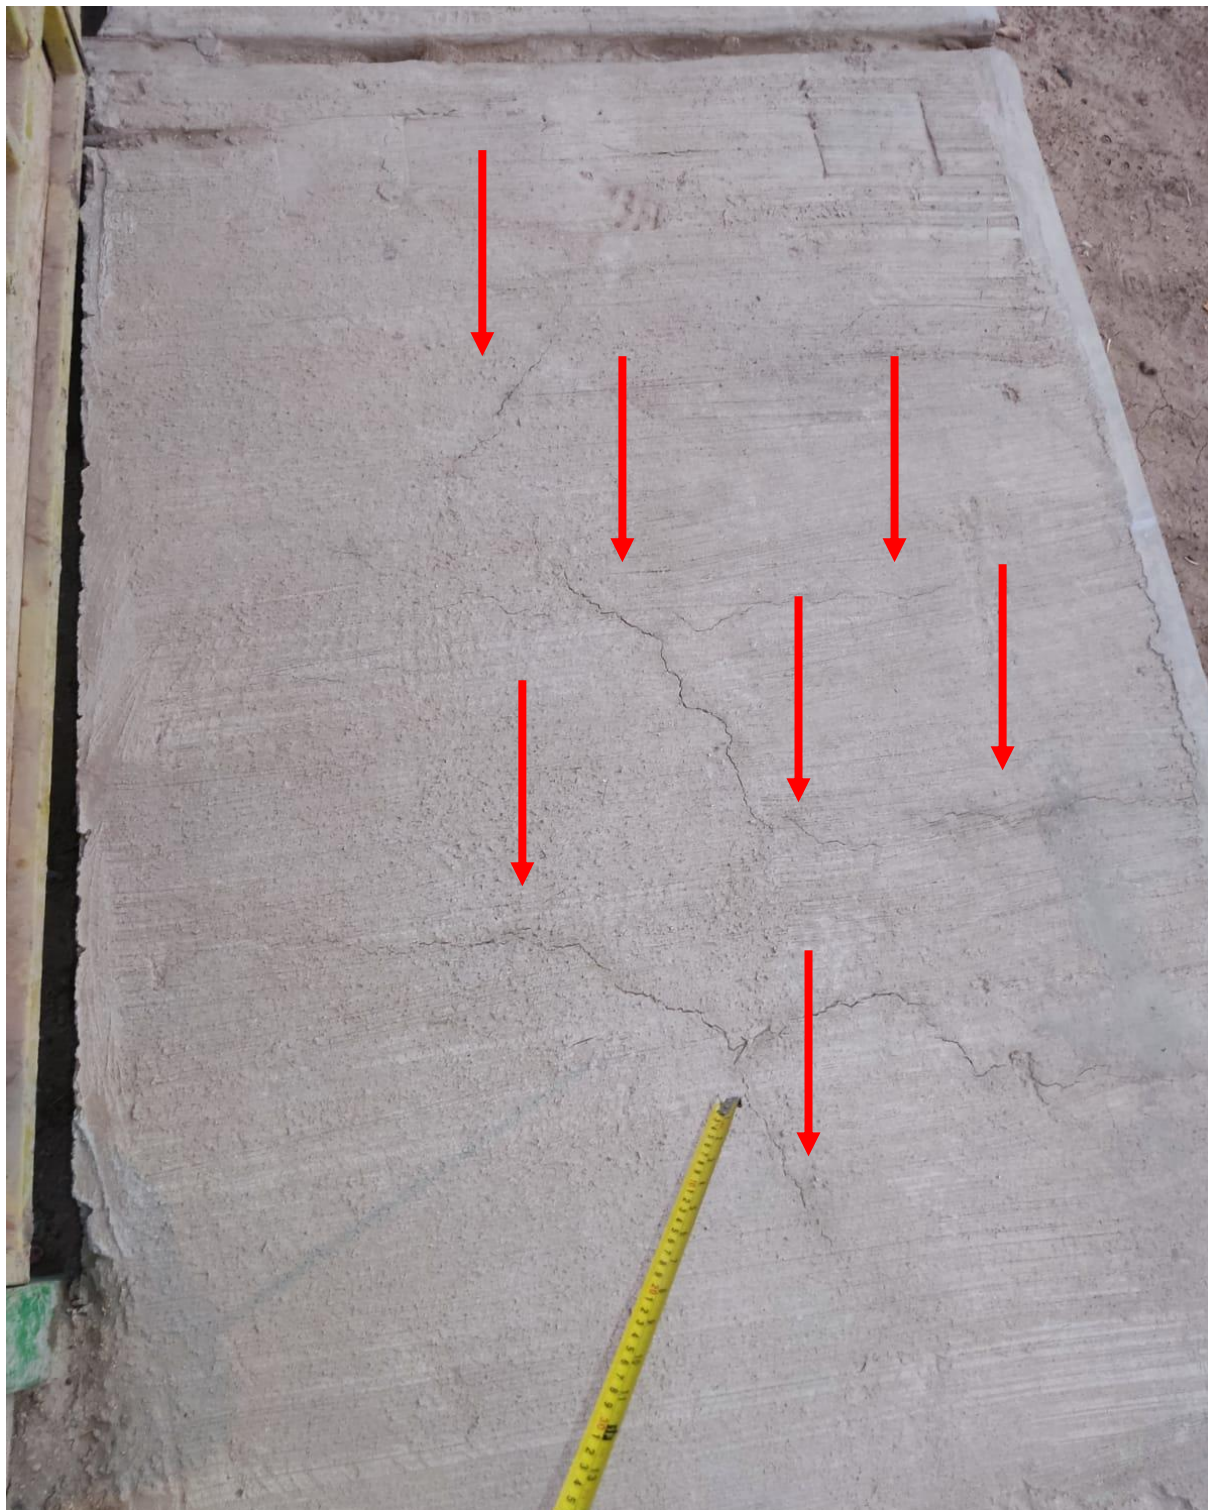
Fisuras en Losa + 20 kg/m³ fibra comercial
